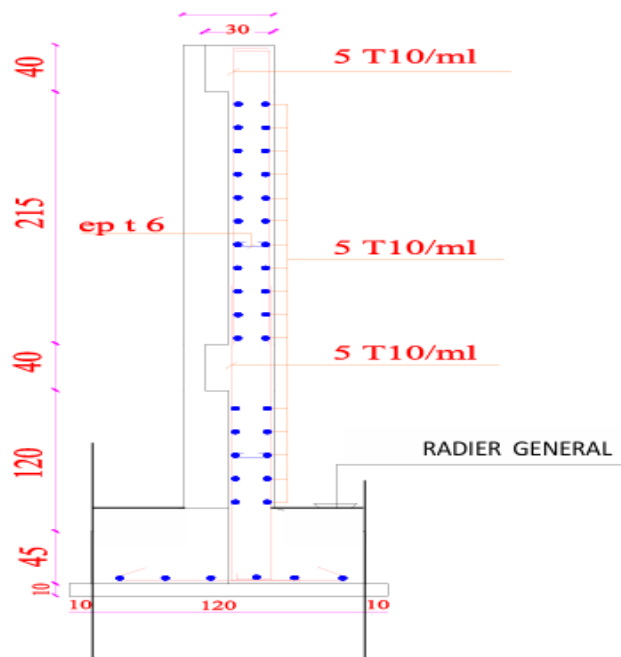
Schéma de ferrailage du voile Périphérique
